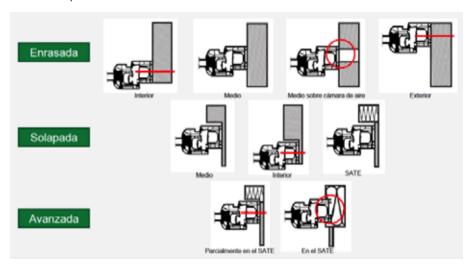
Posibles emplazamientos de la carpintería en un edificio respecto al muro
